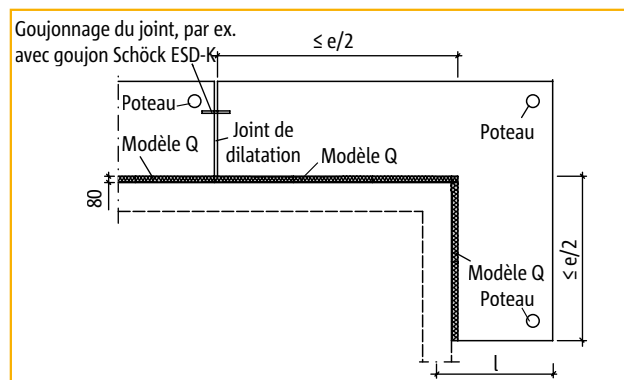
disposition des joints de dilatation sur des dalles de balcon raccordées au niveau d'un angle
